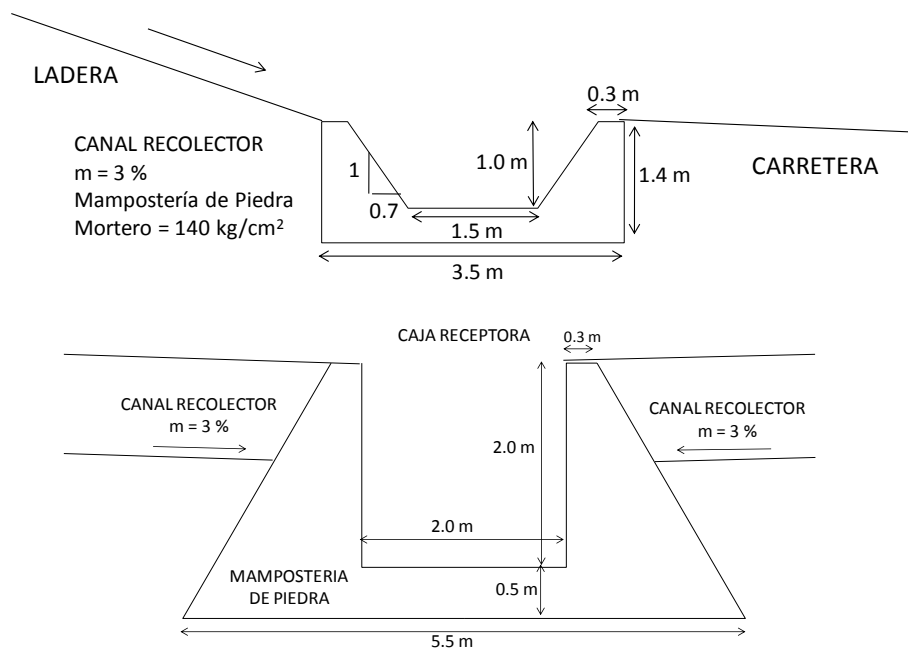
Detalle de canales colectores en la salida de la quebrada El Playón
